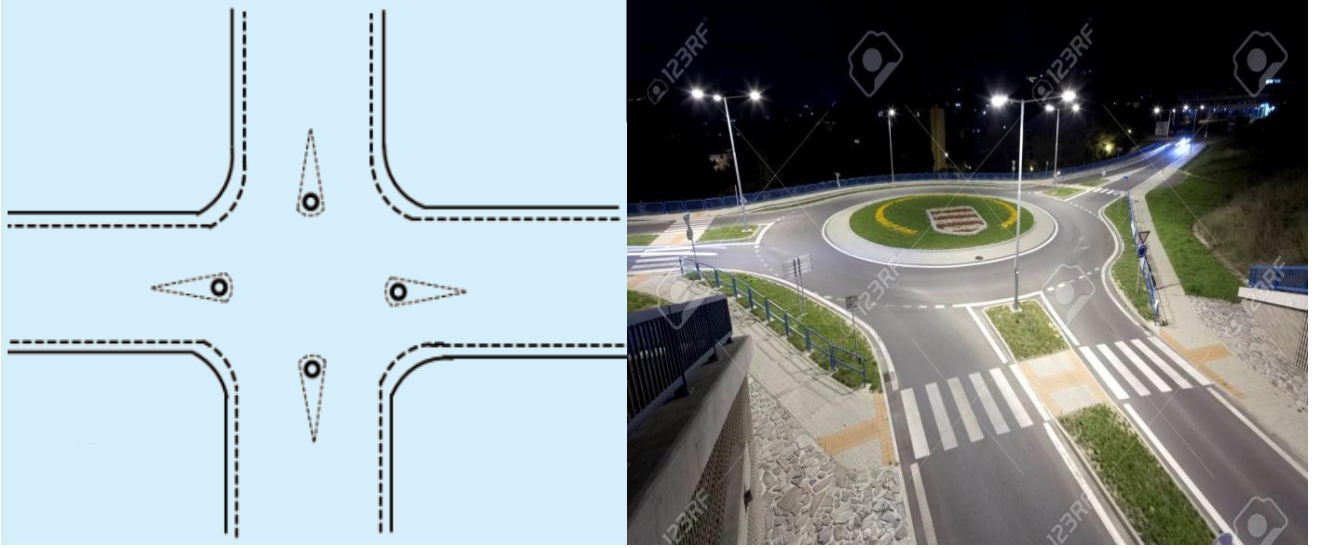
बहुपदरी रस्ता चौका लाइटिंग लेआउट (Lighting layout for multiple road junctions)
